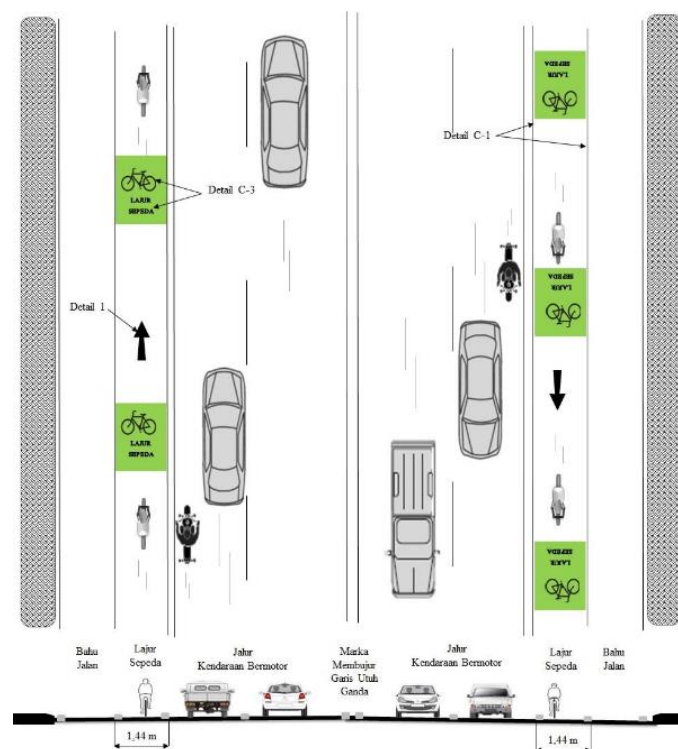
Perspektif lajur sepeda tipe C di badan jalan
